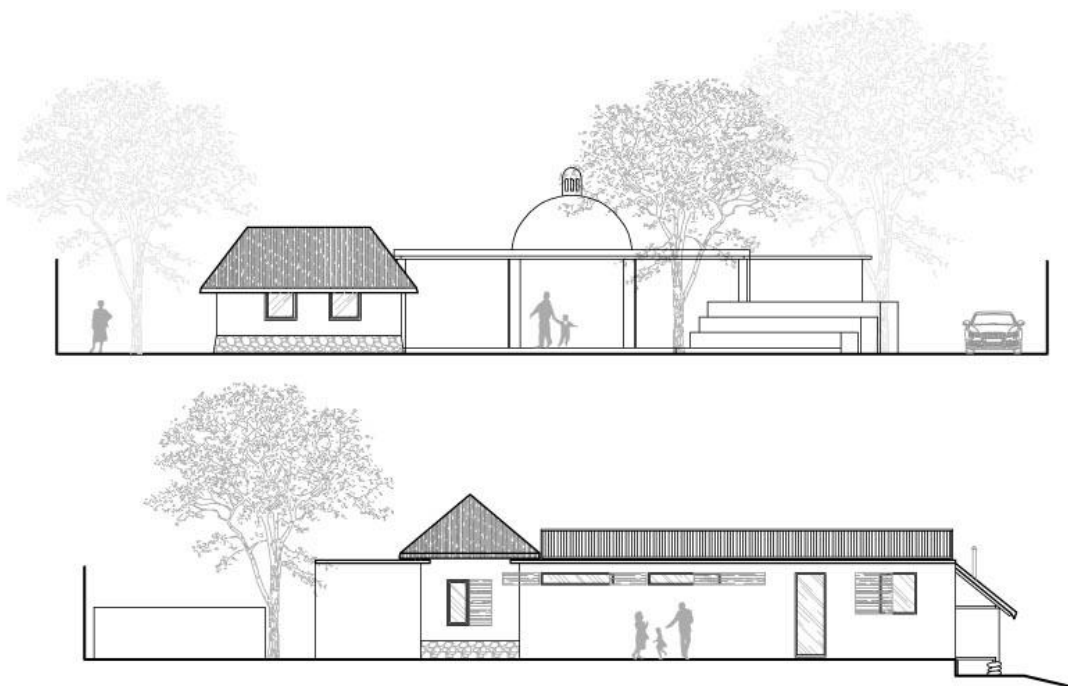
Plano 05; Fachadas NORTE y OESTE del Centro Comunitario de Aprendizaje.
